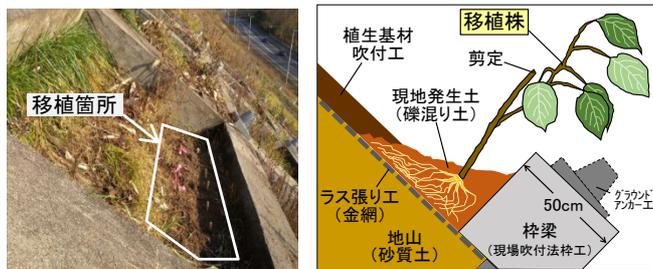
移植法枠の状況 図-1 法枠内への植付け方法
